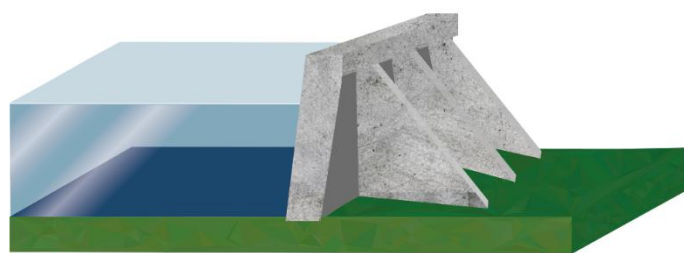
Ilustração de Barragem de Concreto à Gravidade.
